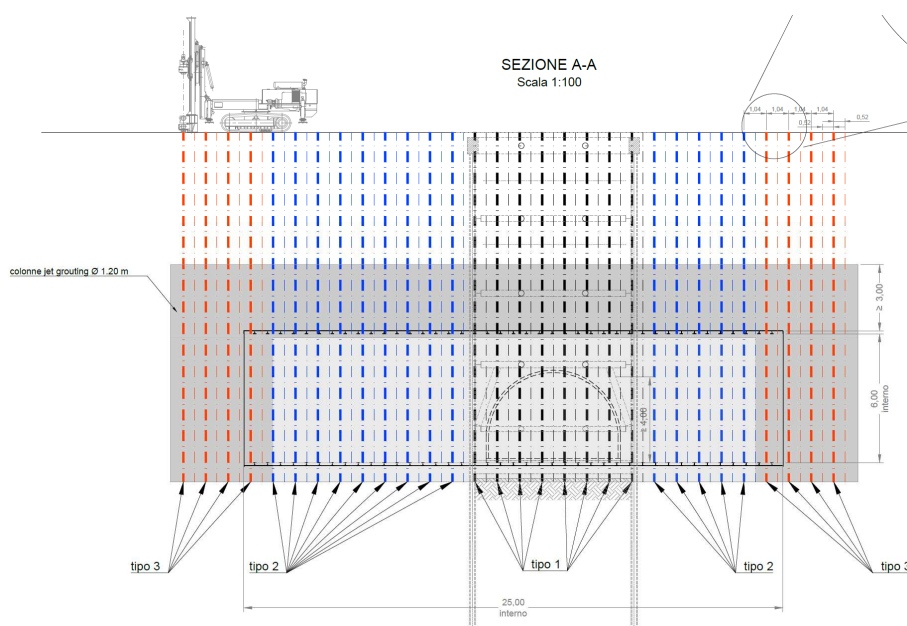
Trattamento jet grouting per il cunicolo PS-GT5: sezione longitudinale.
